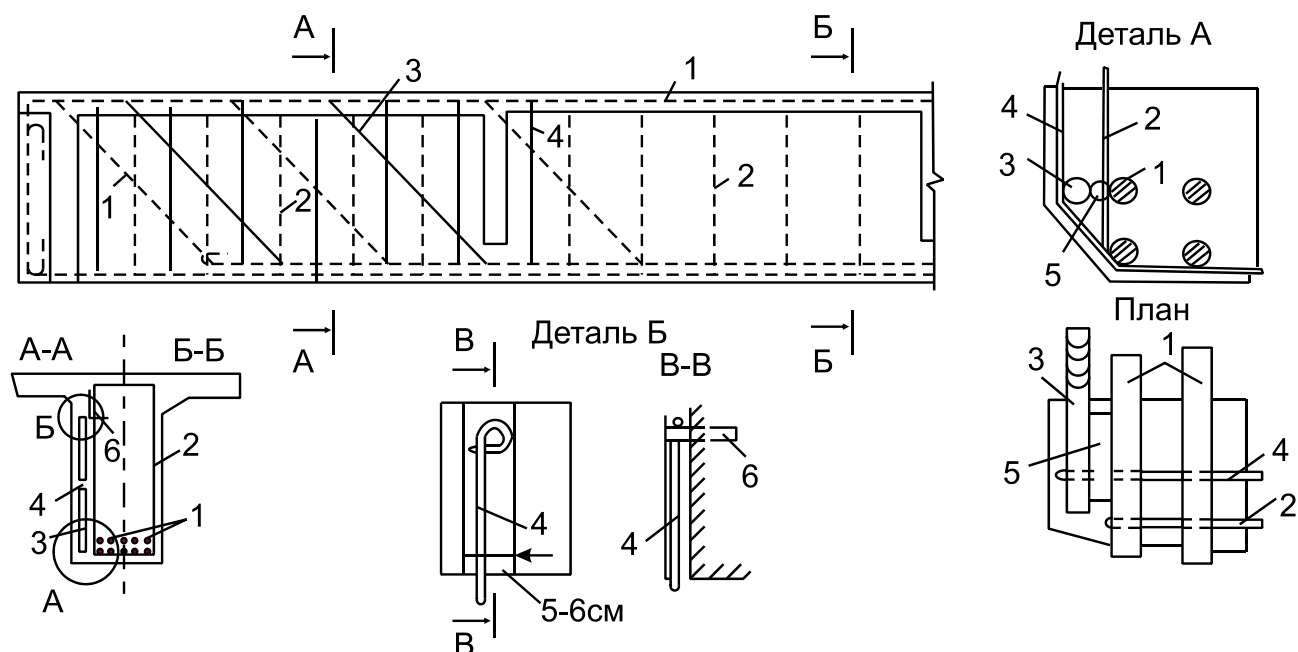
Усиление балок на главные растягивающие напряжения: 1- существующая продольная арматура; 2 – существующие хомуты; 3 – косая арматура усиления; 4 – хомуты усиления; 5 – коротыши для приварки косых стержней; 6 – штыри для крепления хомутов
